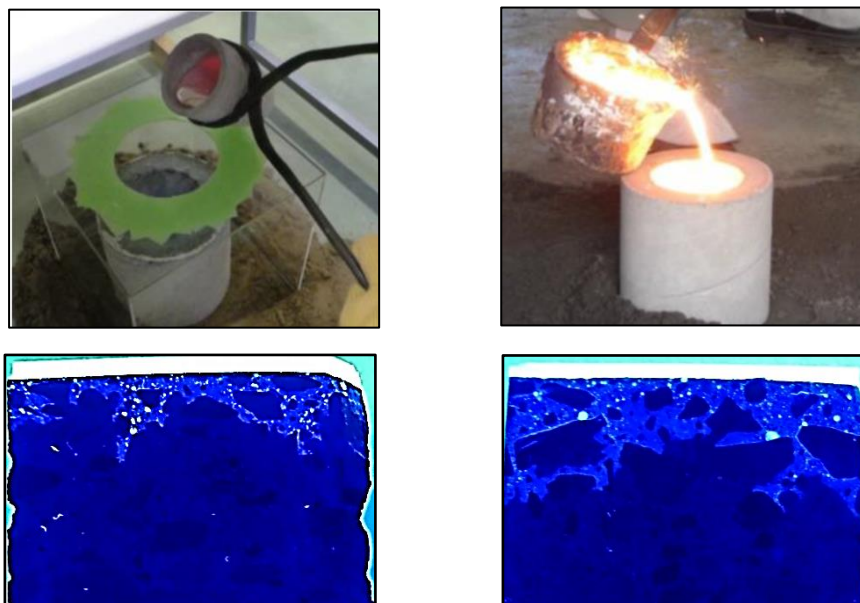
アルミの流し込み状況（左上）とひび割れ確認状況（左下）
